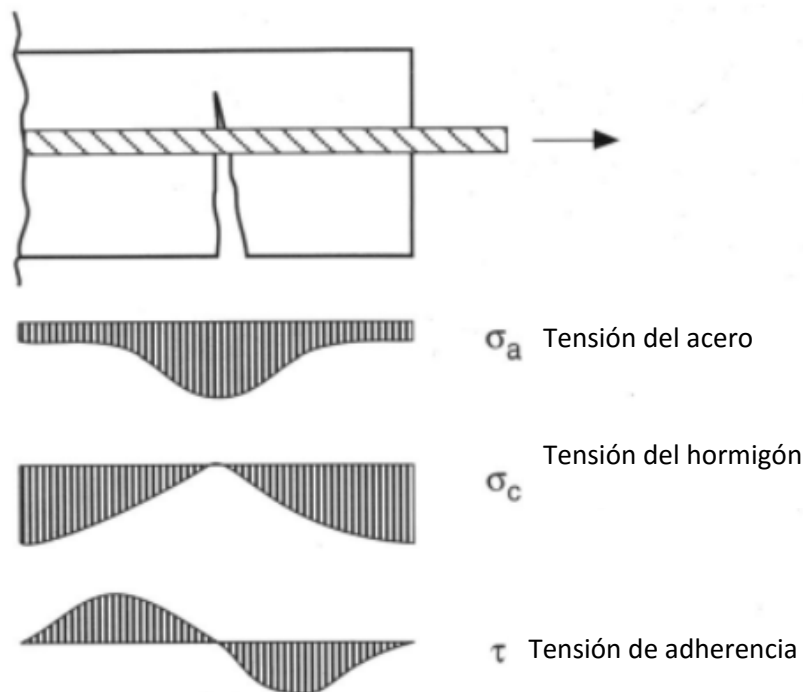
Estado tensional acero-hormigón tras la primera fisura
